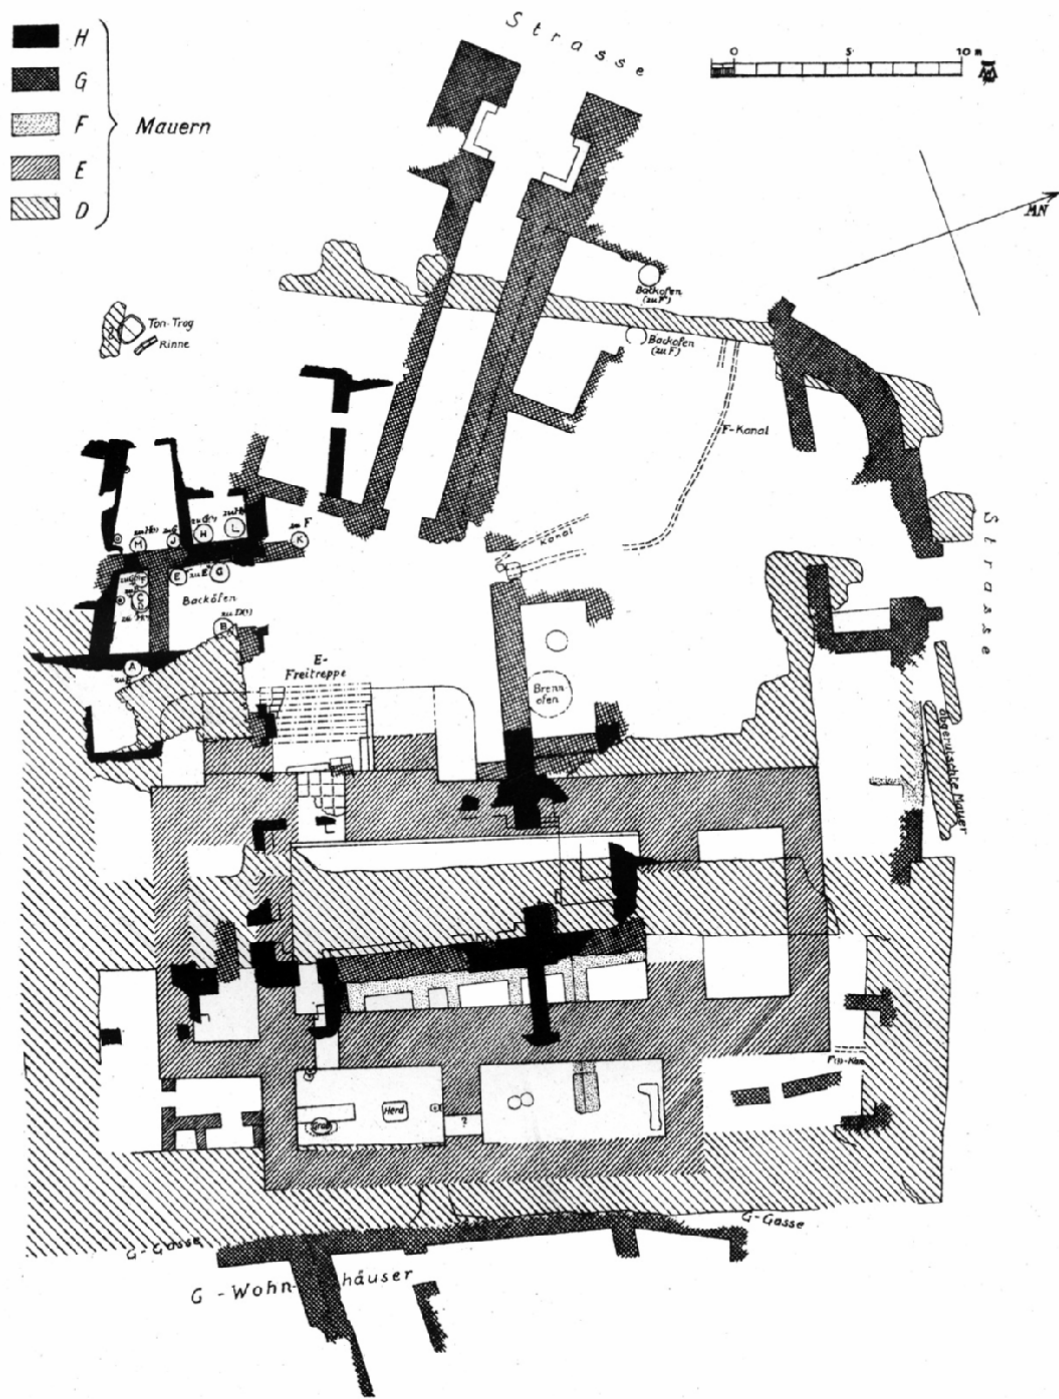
Grundrisse der Schichten H-D (Andrae 1922, Taf. 5)
